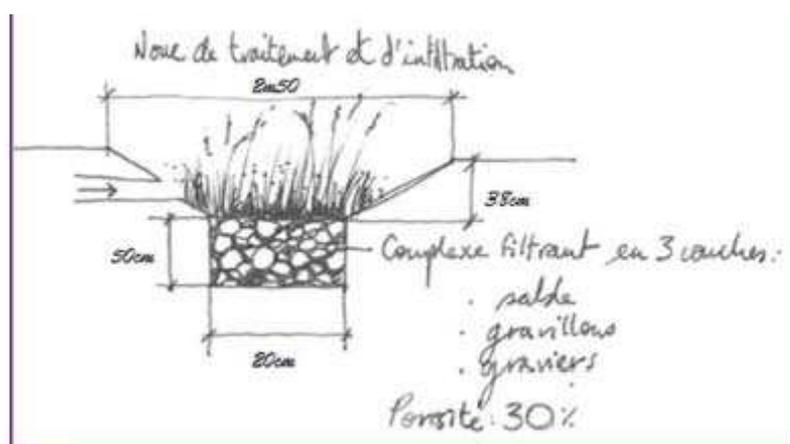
Coupe d'une noue (source : dossier loi sur l'eau, p.73)
